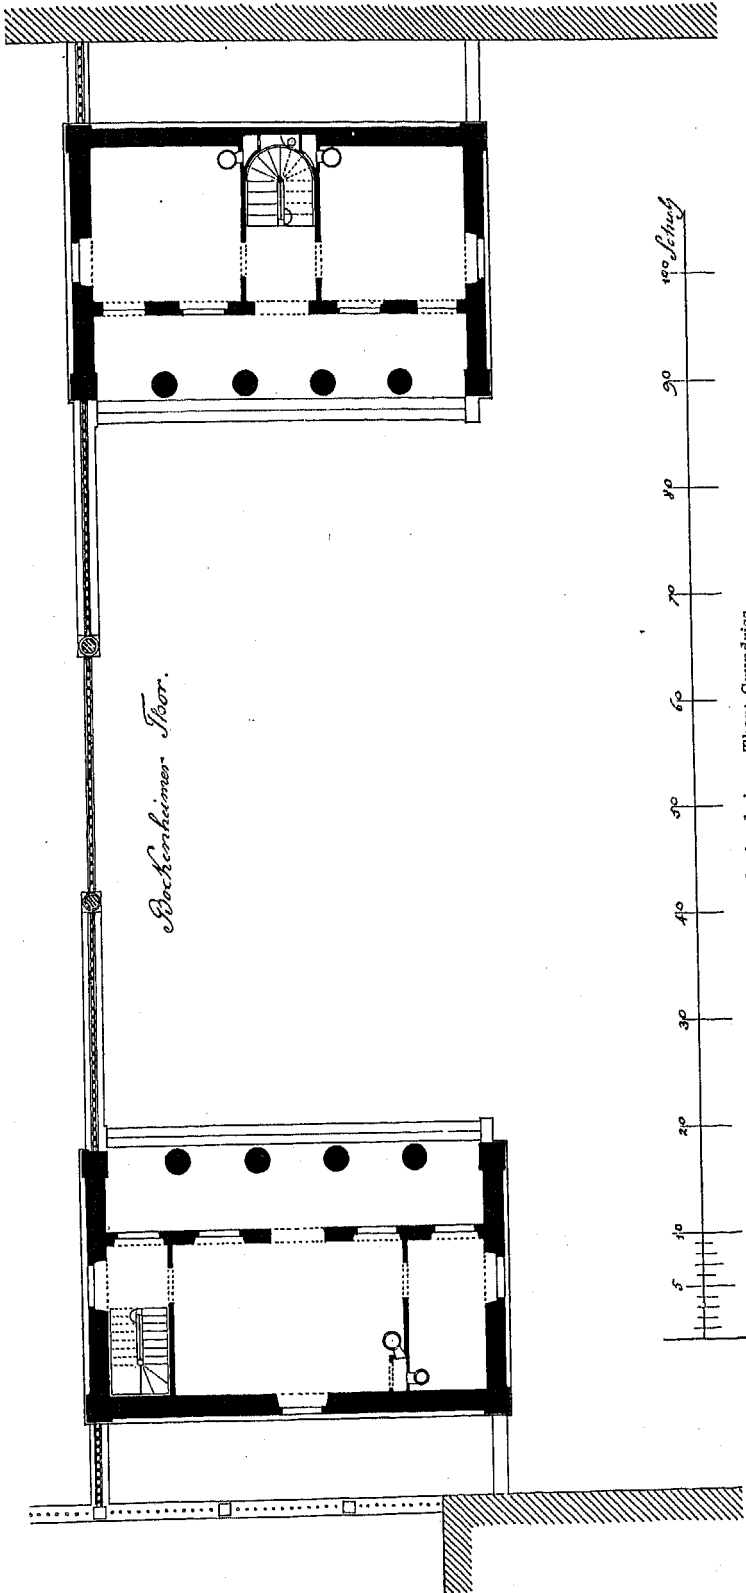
Bockenheimer Thor; Grundriss.
